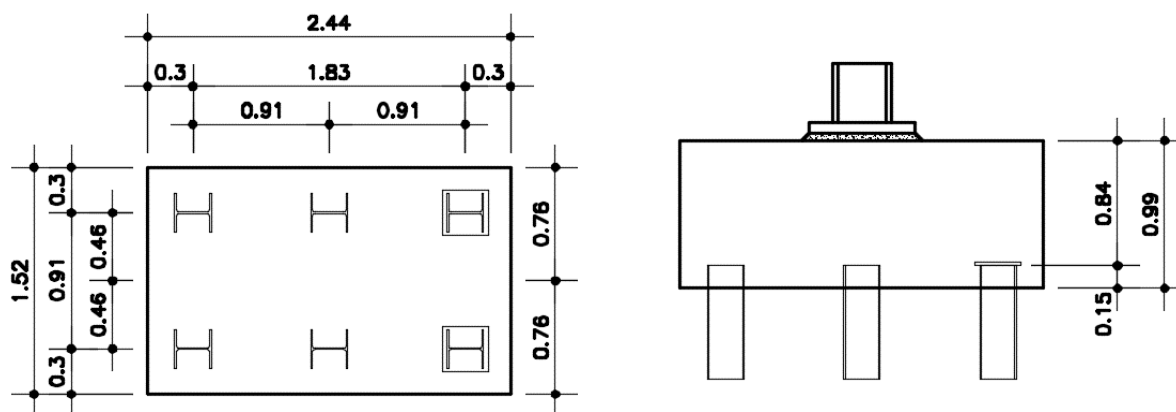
Vista em planta e elevação do Bloco 1, com dimensões em metros
